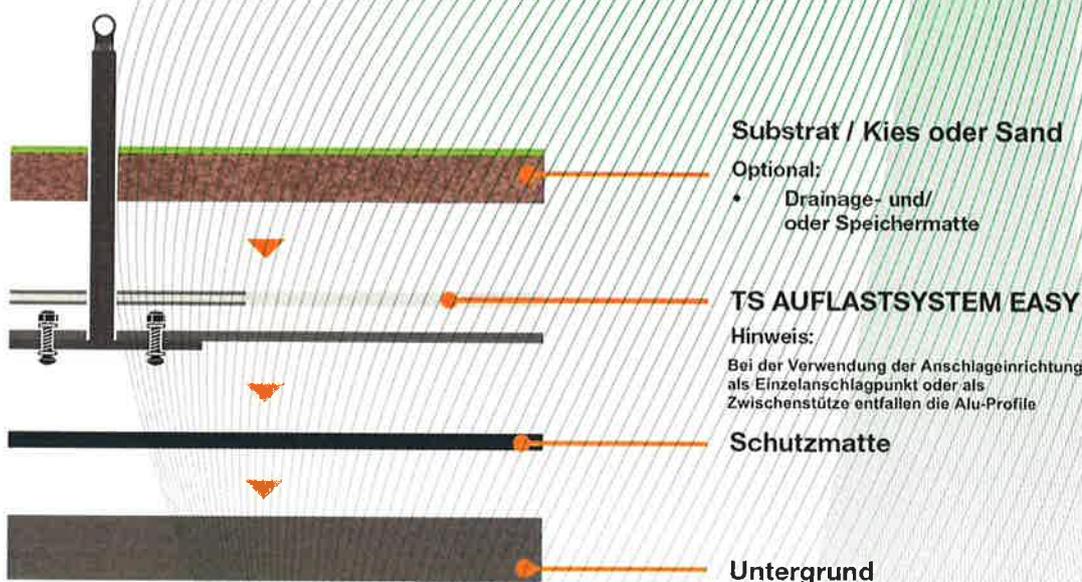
Anschlageinrichtung, Typ: TS Auflastsystem EASY
